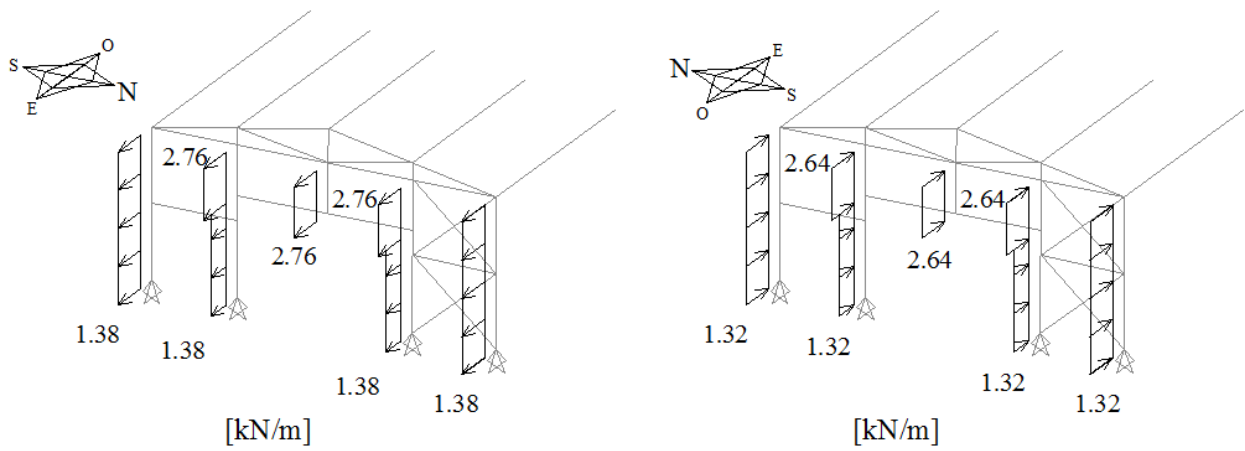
Vento W2 nas fachadas orientadas a Este e Oeste na situação 1 (EC1.1.4)
